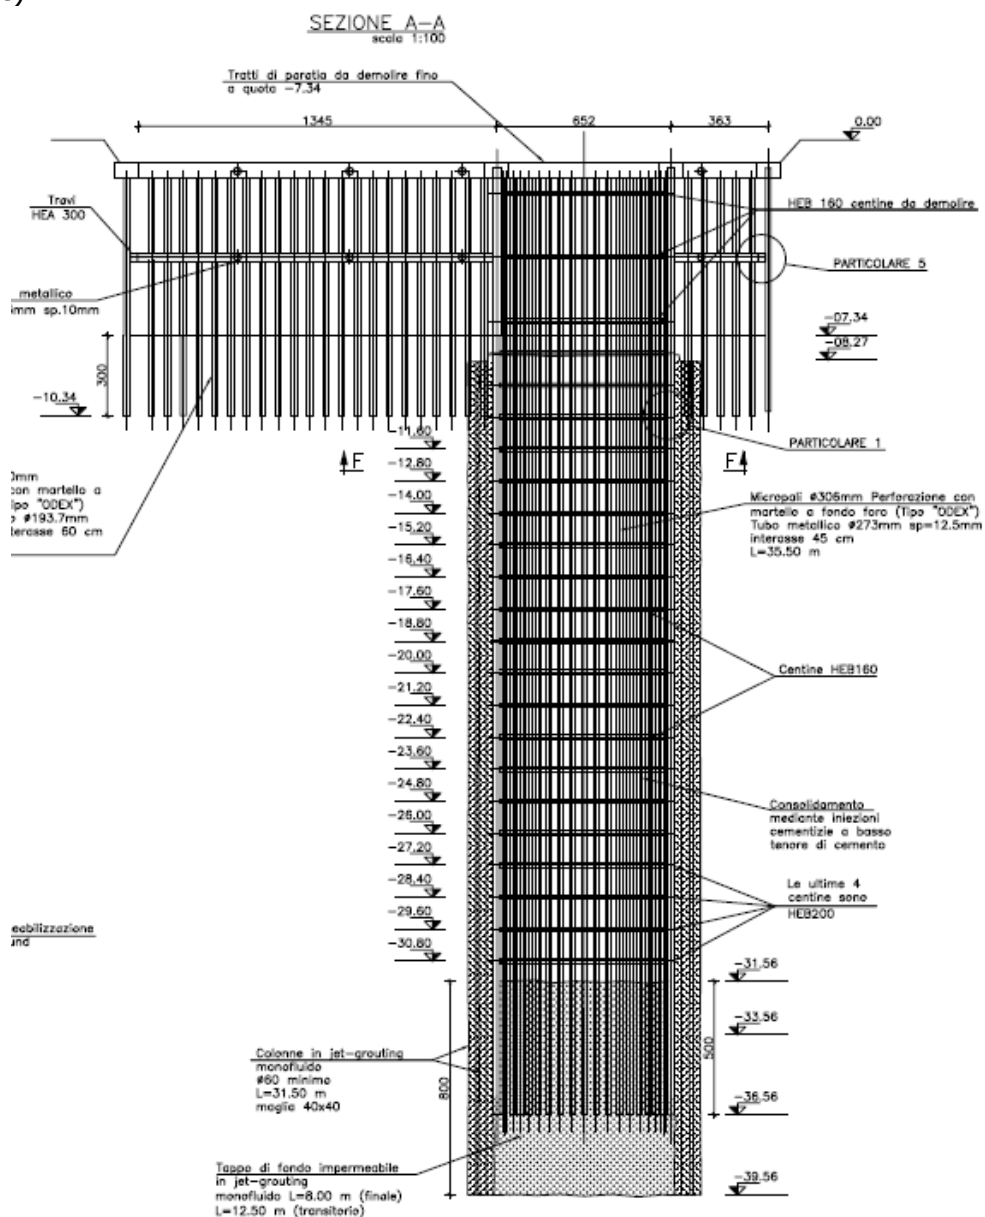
Esempio di opere di contenimento degli scavi per pozzo verticale – Sezione
